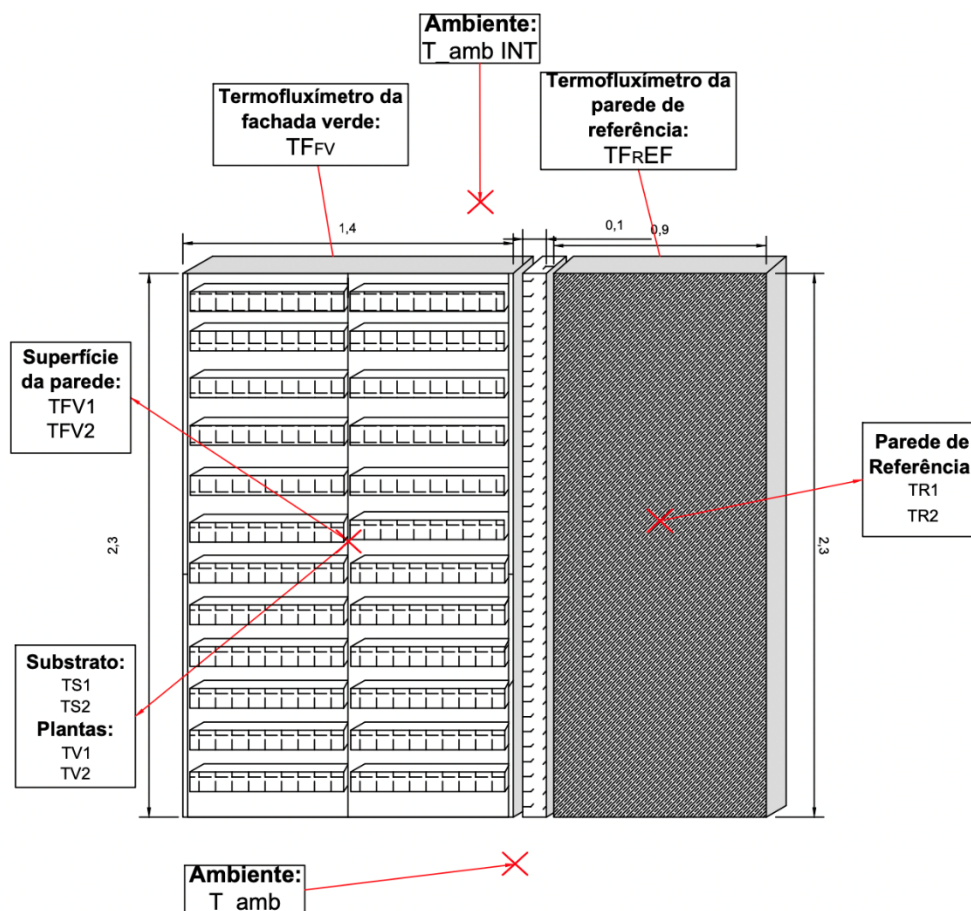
Esquema representativo da instalação dos termopares e termofluxímetros do sistema modular de fachada verde (unidades em m).
